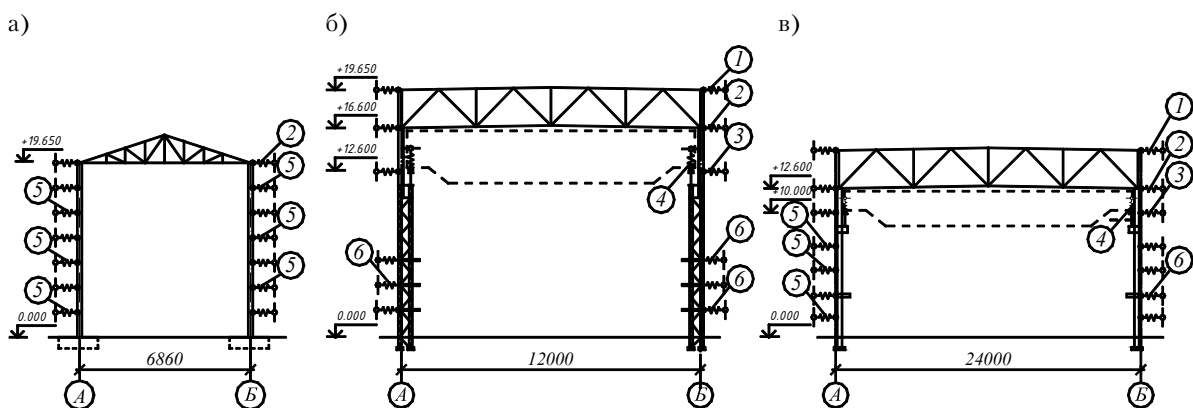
Моделі поперечних рам каркасів із пружними в'язями: а) поперечна рама дослідного каркаса; б) поперечна рама каркаса варіанта 1; в) поперечна рама каркаса варіанта 2. Позначення: 1 – покрівельний диск; 2 – горизонтальні в'язі по нижніх поясах кроквяних ферм; 3 – гальмівні конструкції; 4 – підкранові балки; 5 – горизонтальні ригелі позовжнього фахверка; 6 – технологічні майданчики.
